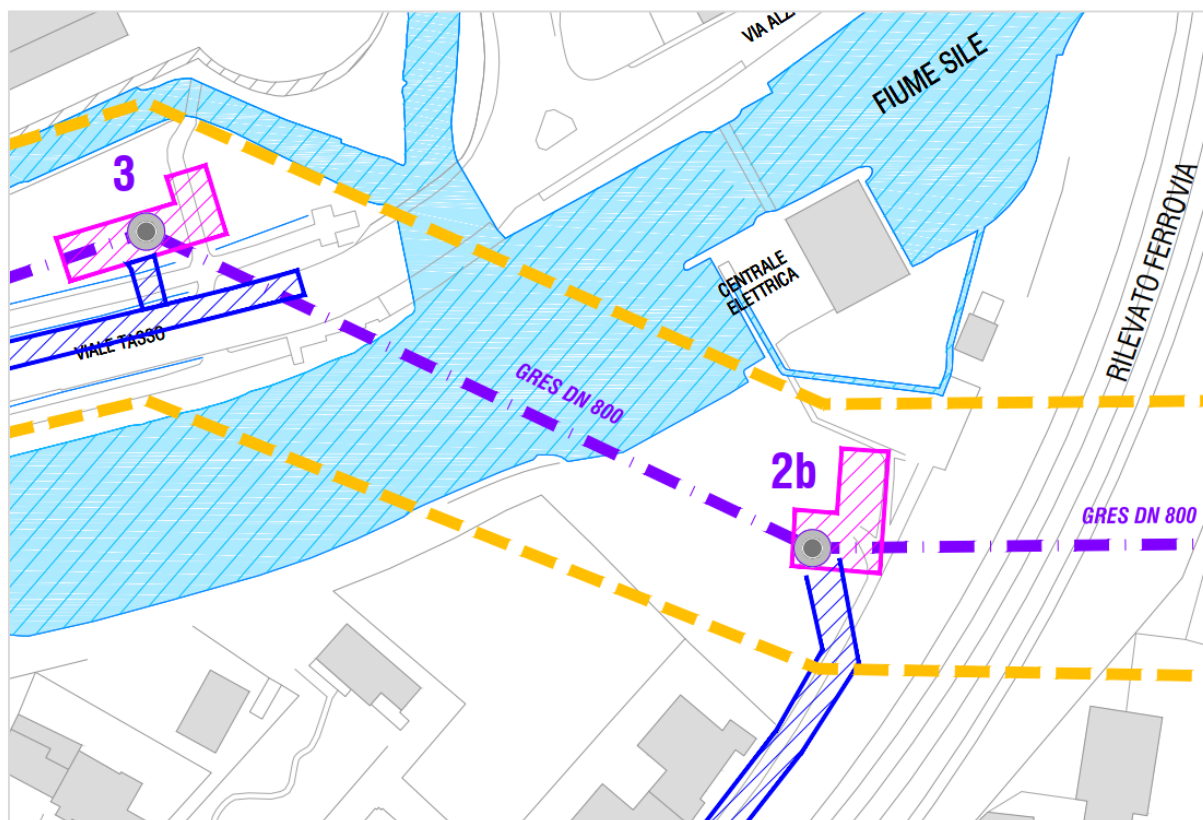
G : Inquadramento planimetrico tratta pozzo S2b – S3
